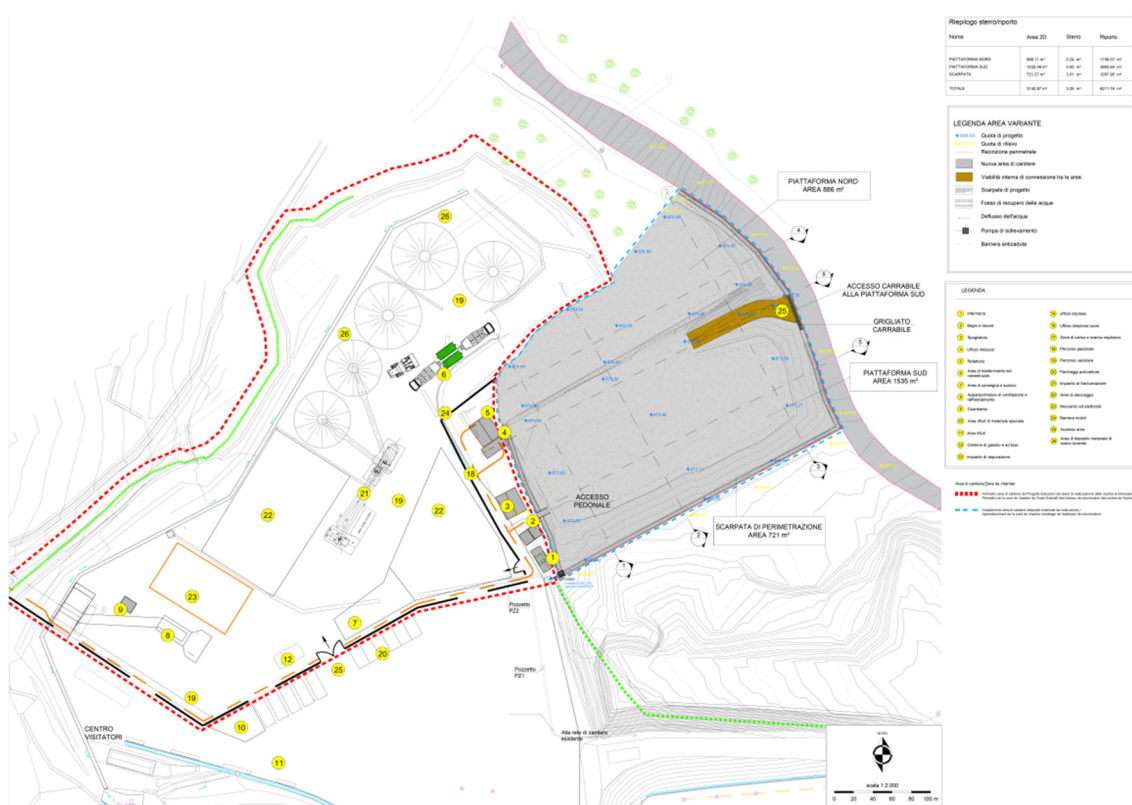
Stralcio planimetrico della riconfigurazione dell’area di cantiere.
